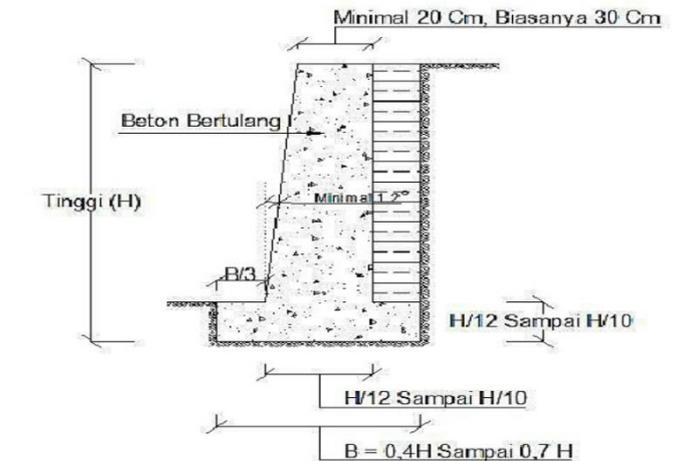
Dinding penahan tanah tipe gravitasi (*gravity wall*)
